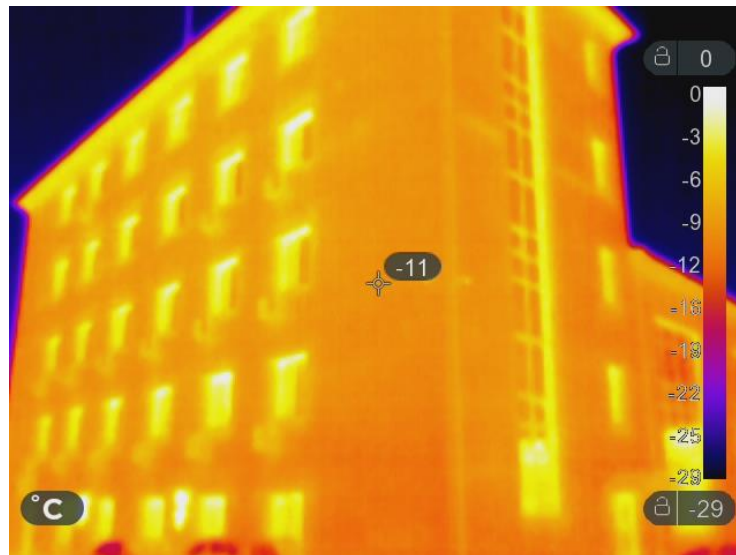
Тепловізійне фото фасаду будівлі
